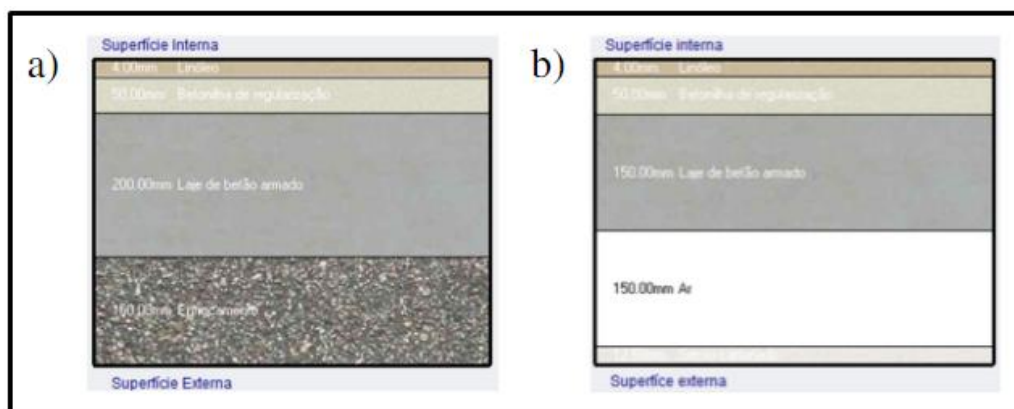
Pormenores construtivos dos pavimentos: a) Pavimento térreo P1; b) Pavimento intermediário P2
